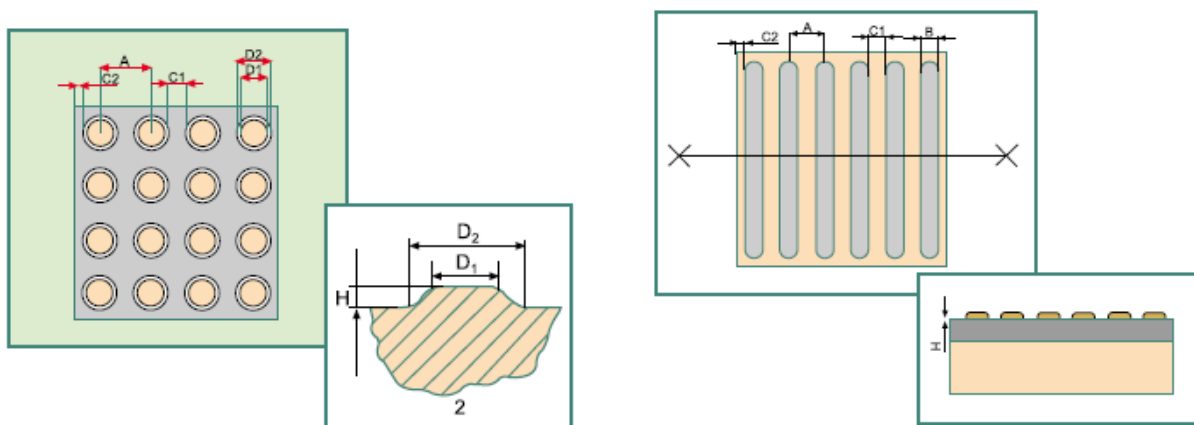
Baldosas de pavimentos direccional y de advertencia.³⁴
